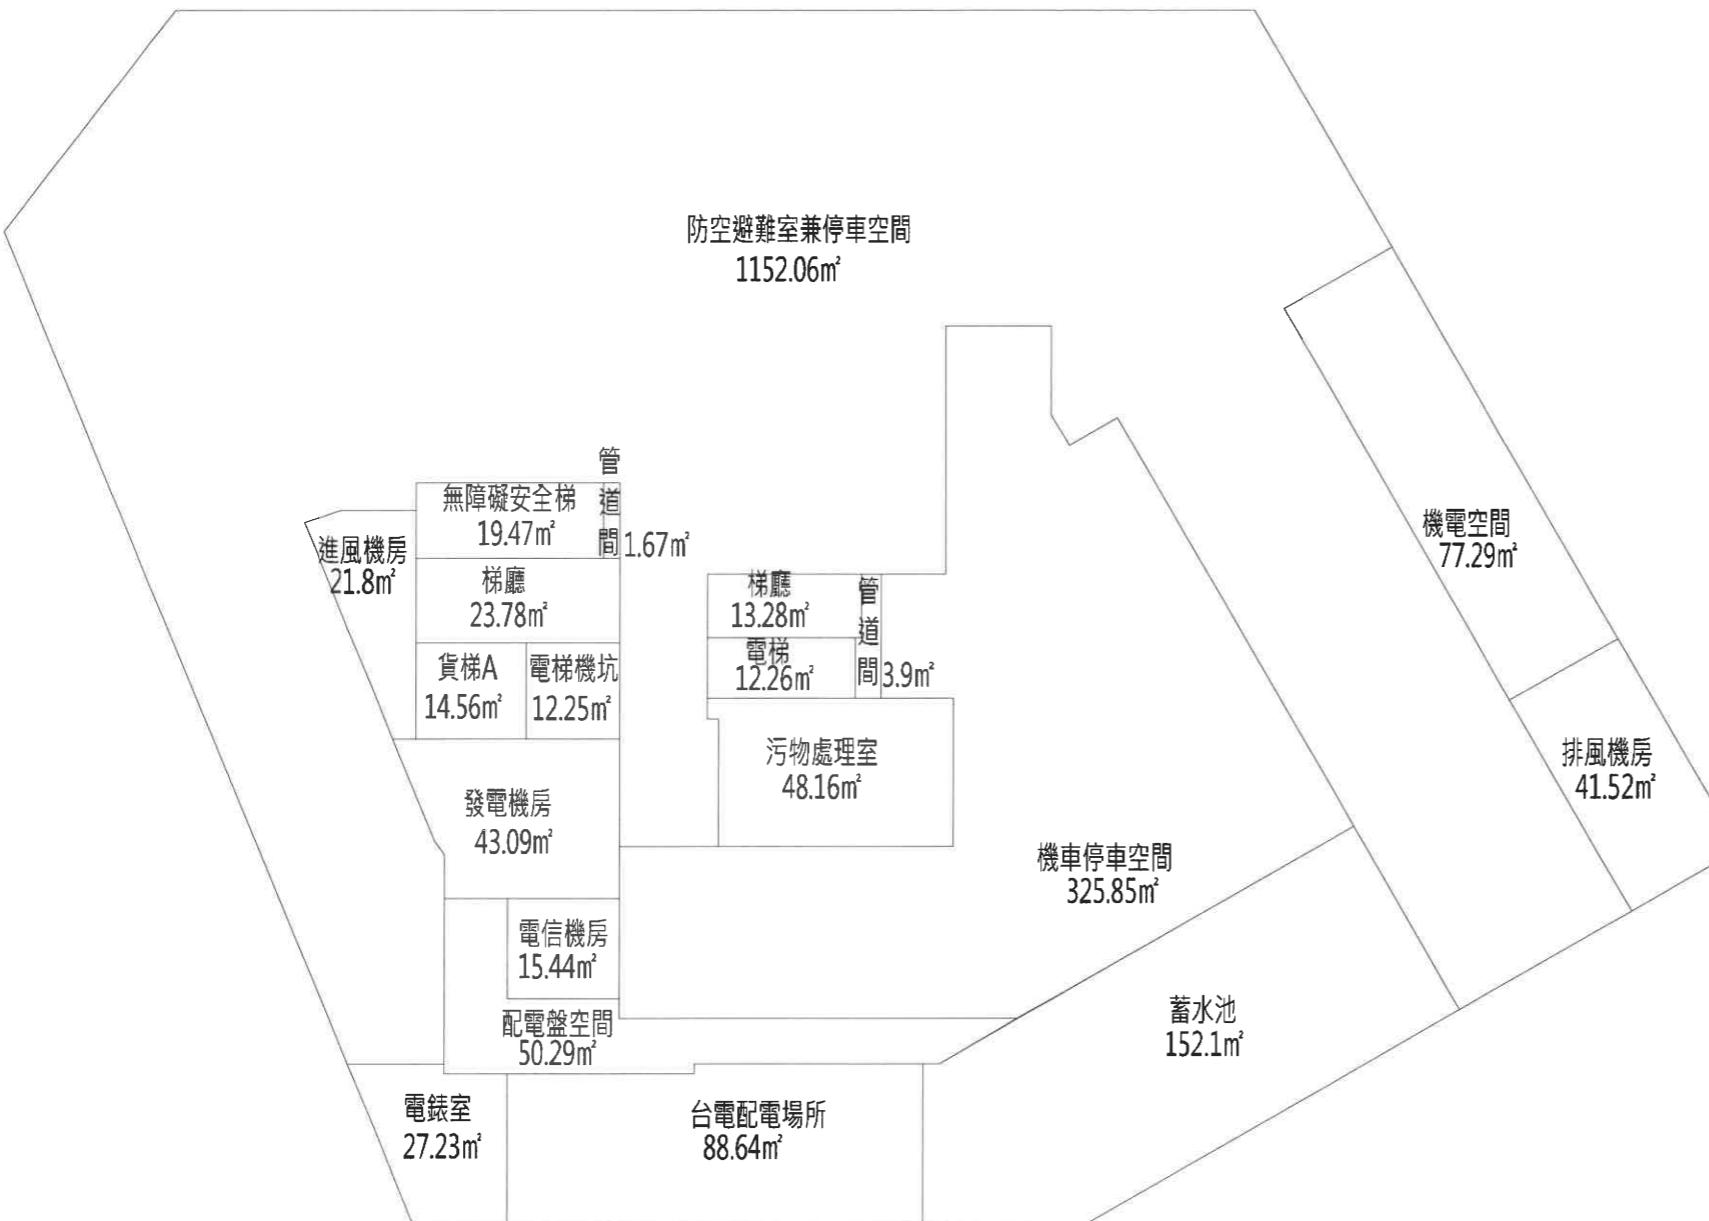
地下一層平面圖(變更後)(S : 1/300)
